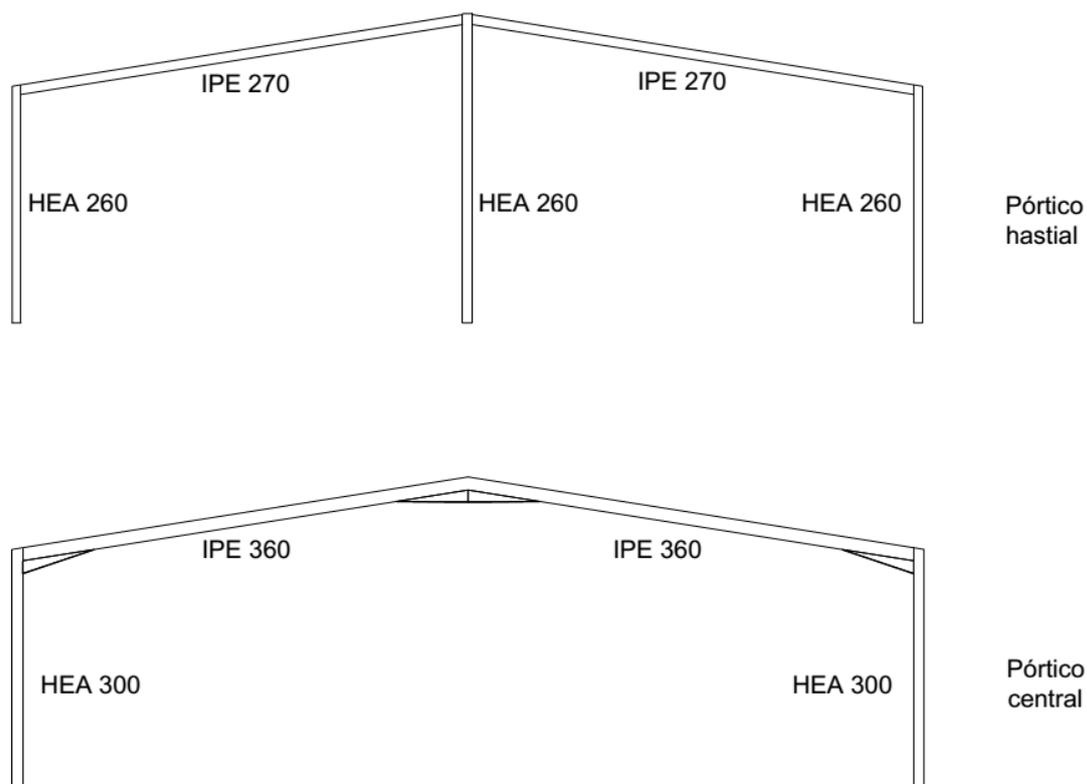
Perfiles empleados en la estructura. Elaboración propia
